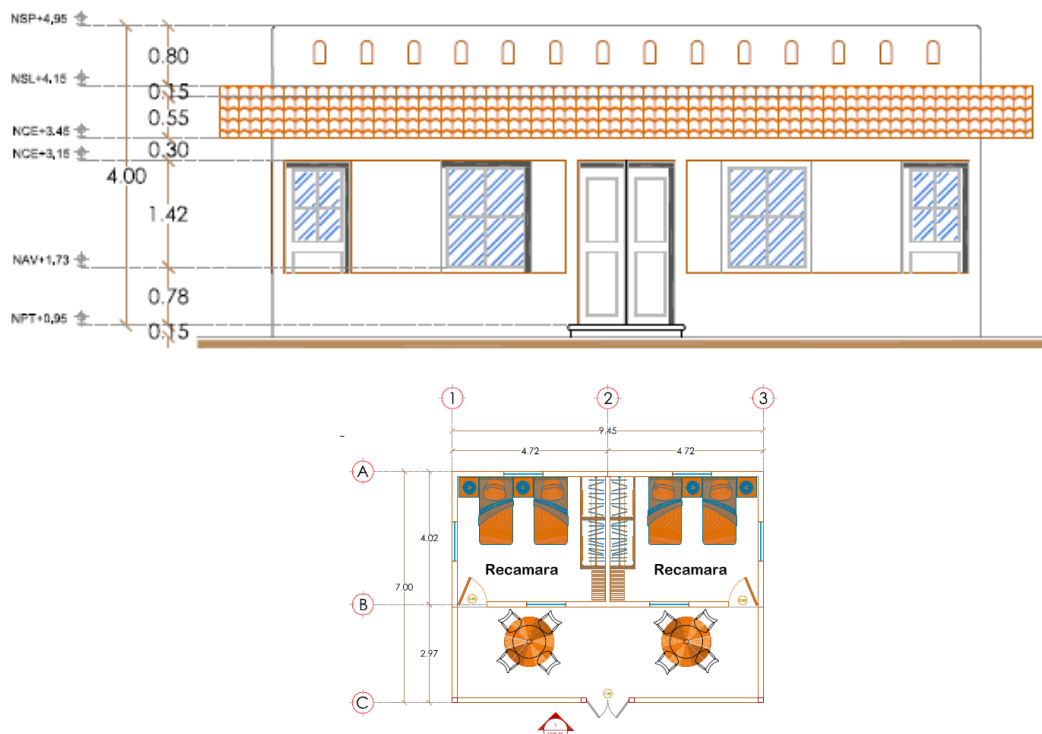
Alzado arquitectónico Área de Dormitorios
